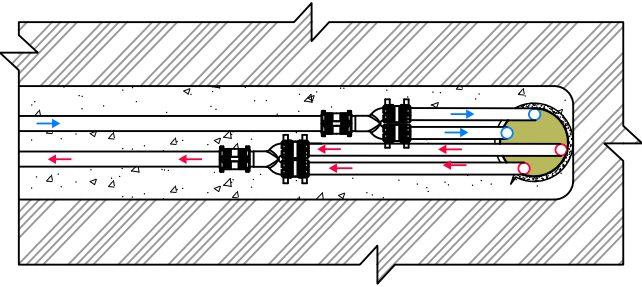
DETAIL VRATNÉHO U - KOLENA SE SEPARAČNÍ JÍMKOU M 1:5
